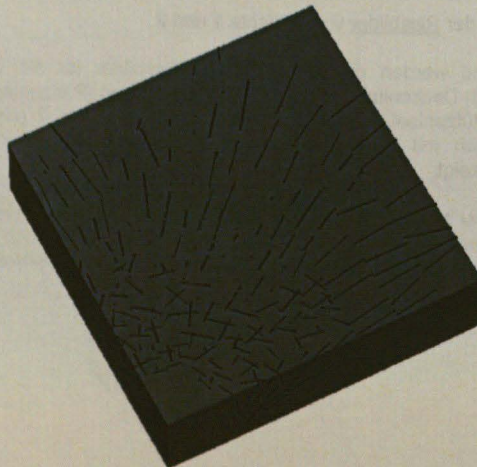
Deckenknoten mit Biegerissen mit Panzerung, Rissbild bei Stützenlast 7000 kN. Maximale Rissbreite 0.56 mm, minimale gezeigte Rissbreite 0.03 mm
